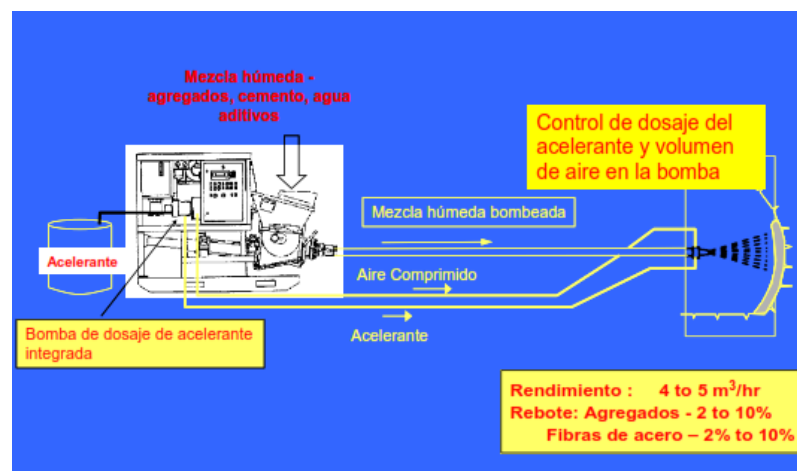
Equipo de lanzamiento de concreto vía húmeda.
